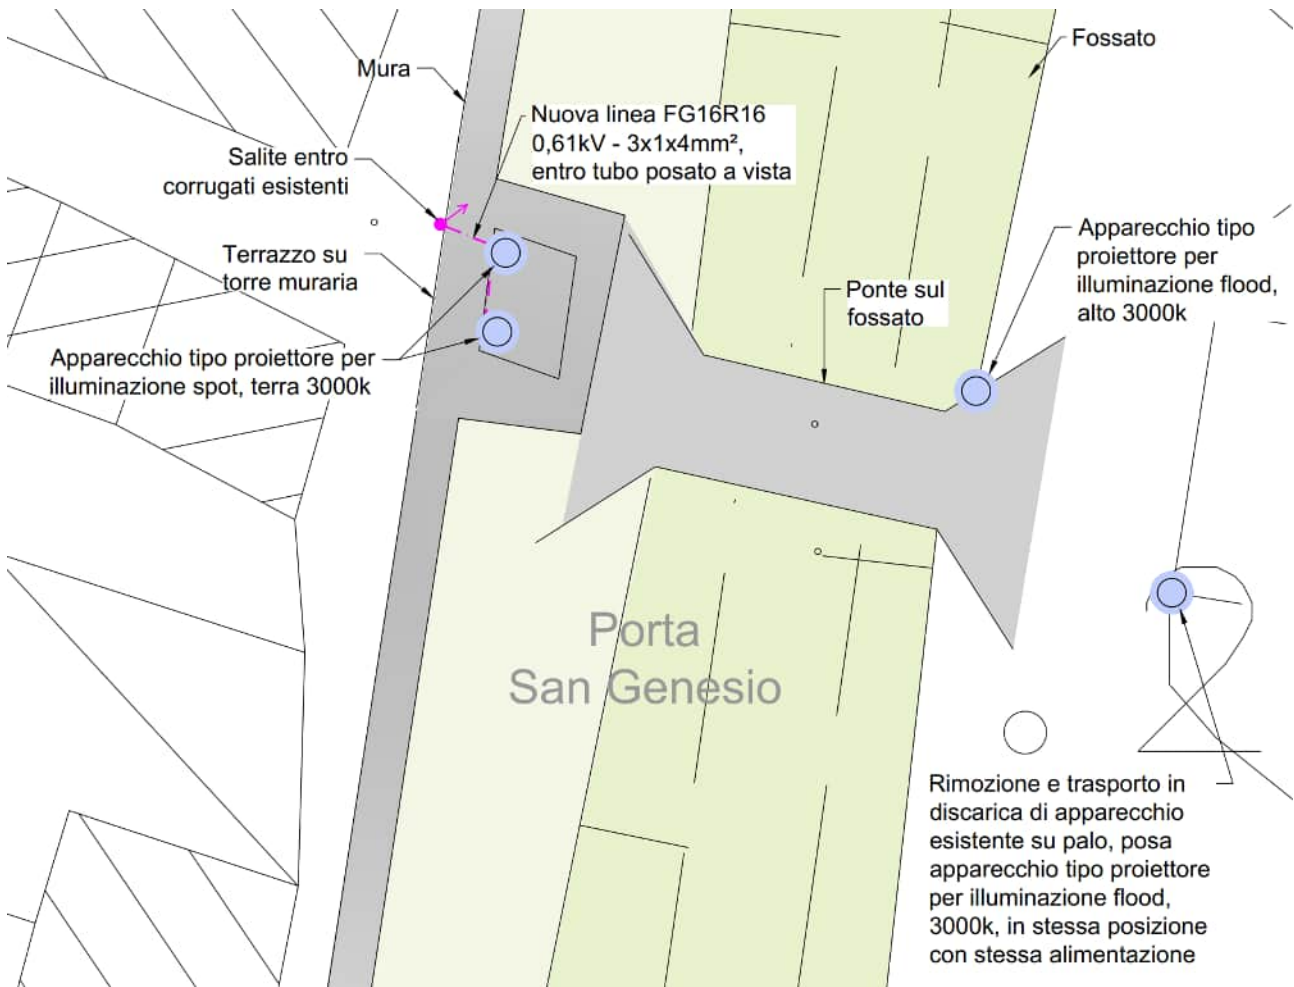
Planimetria di progetto illuminazione Porta San Genesio
